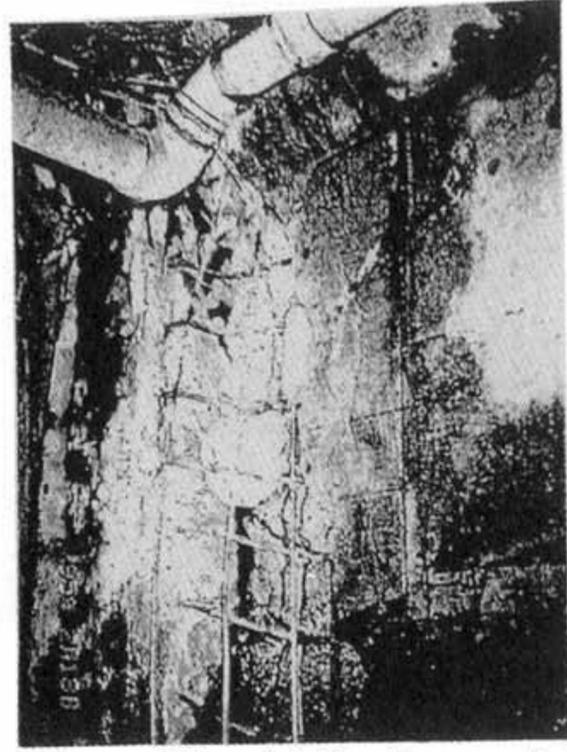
三宮第2駐車場・壁のコンクリート剥落・鉄筋露出(被害タイプA)
